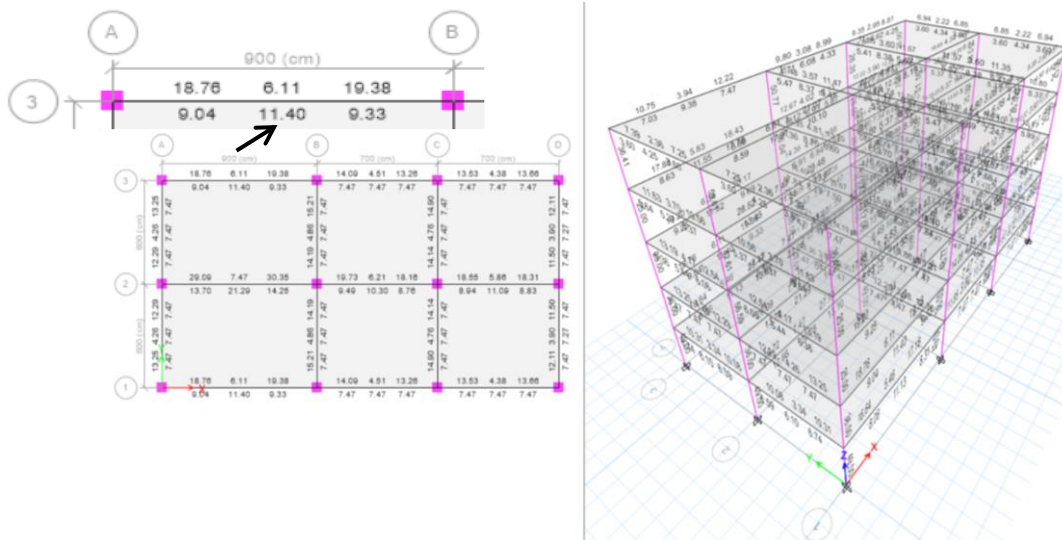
ETABS Área de acero de refuerzo en vigas del edificio de hormigón alternativo
